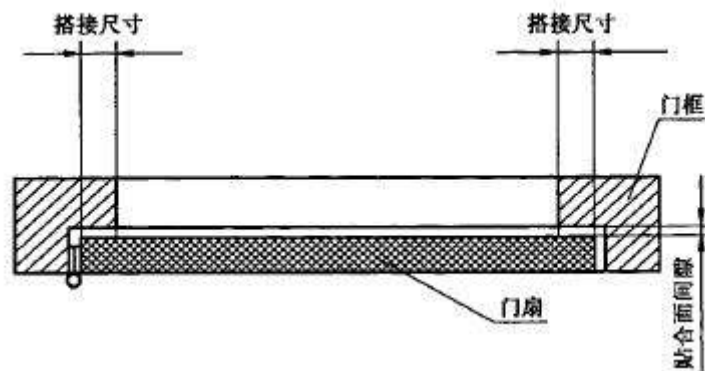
门扇与门框的搭接尺寸和贴合面间隙示意图
